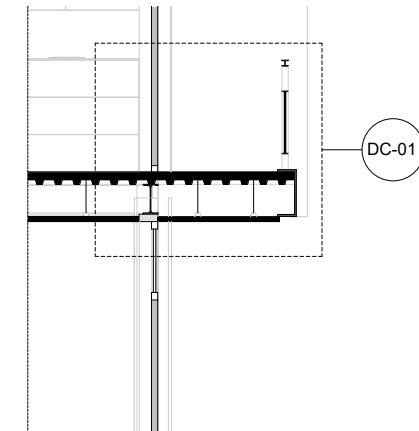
Sección constructiva 01 Fuente: Elaboración Propia
